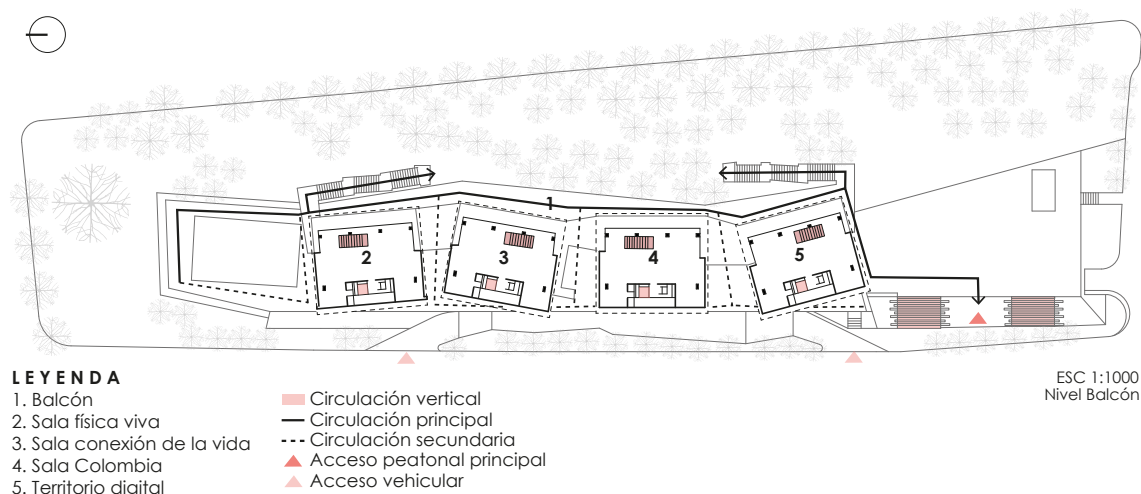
Planta arquitectónica Parque Explora. Elaboración: Autora
